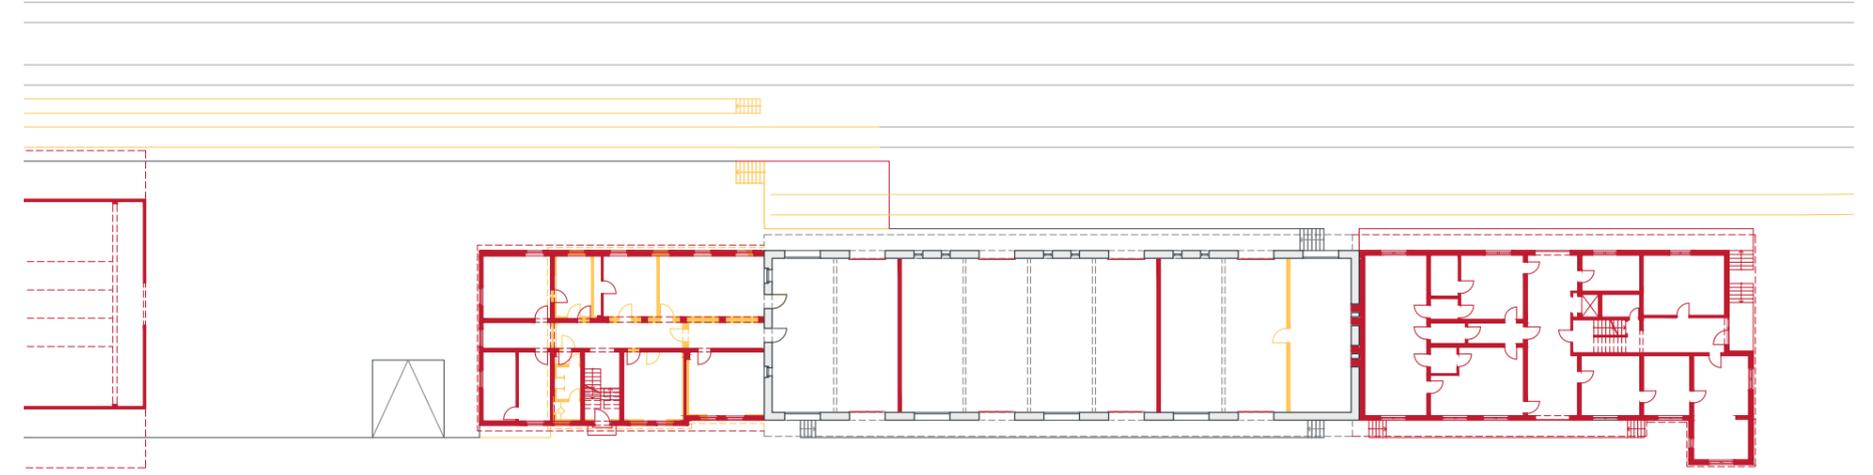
Zollamt und Zollschuppen: Erdgeschoss mit baulichen Veränderungen, 1904-2022 M 1:500
